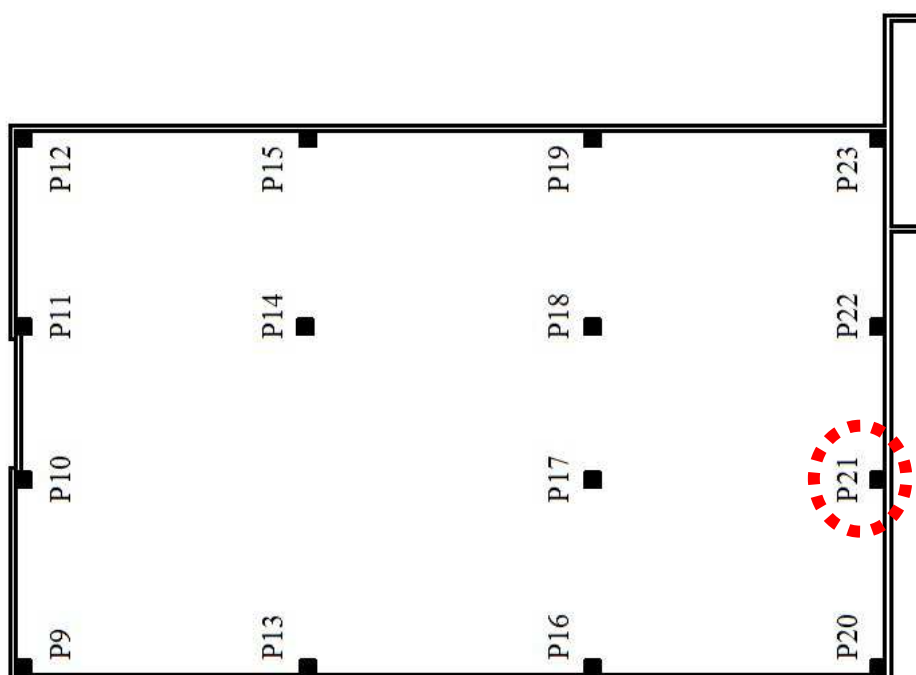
Schema planimetrico padiglione EXPO con evidenza nodii non verificati
